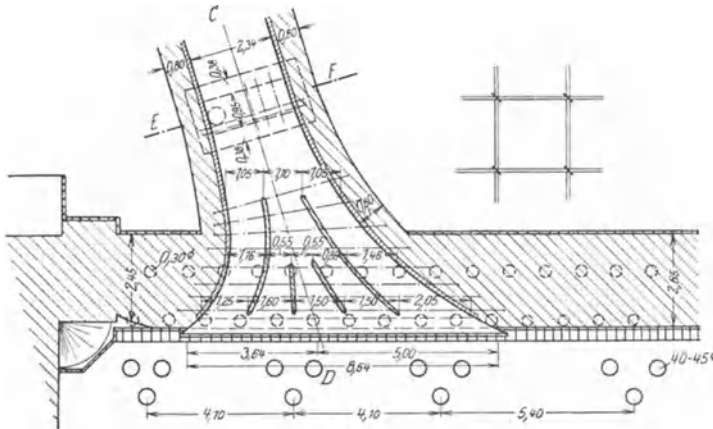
Ausmündungsbauwerk in Berlin (nach Hahn und Langbein).
